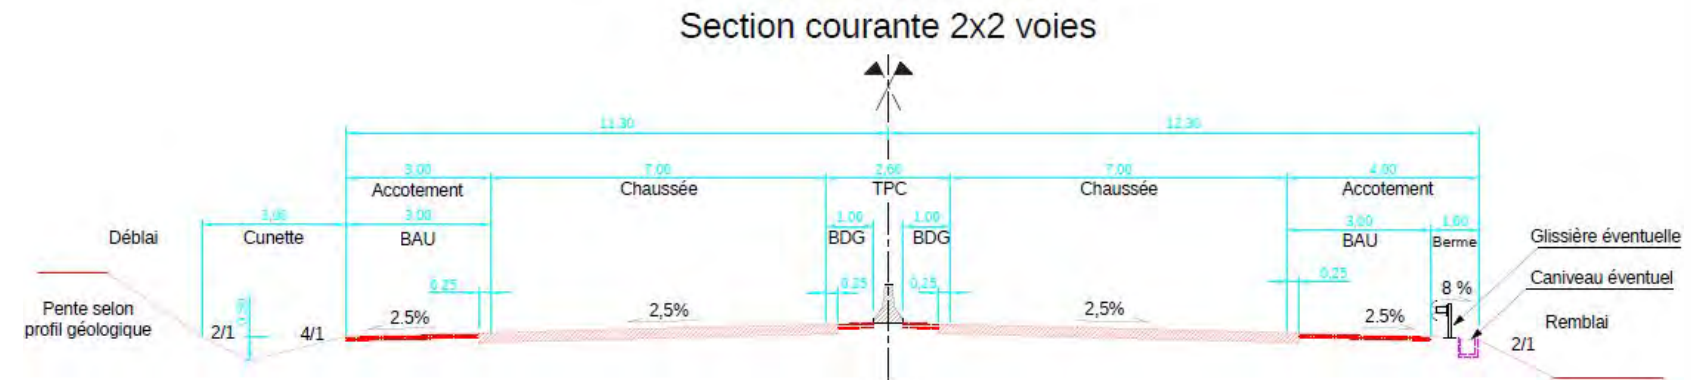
PROFIL EN TRAVERS TYPE DE LA SECTION COURANTE
